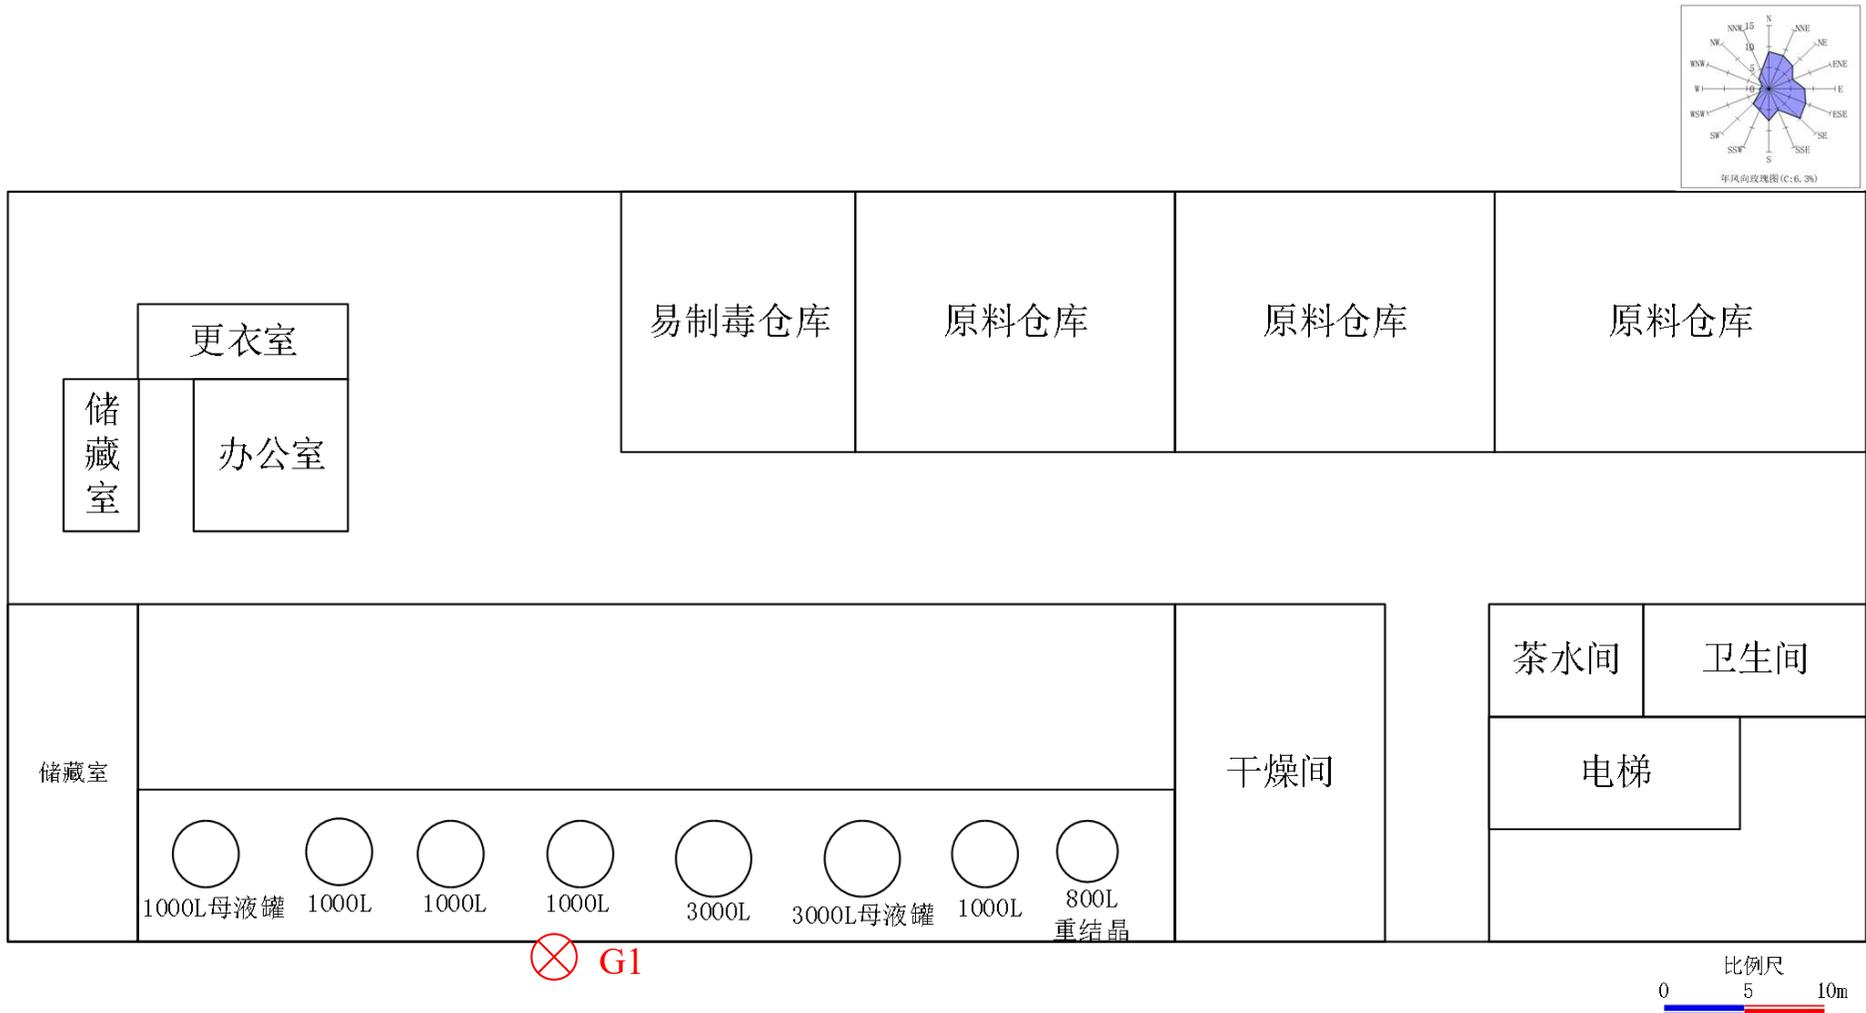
生产车间二（二氢燕麦生物碱成产车间）平面布置图
